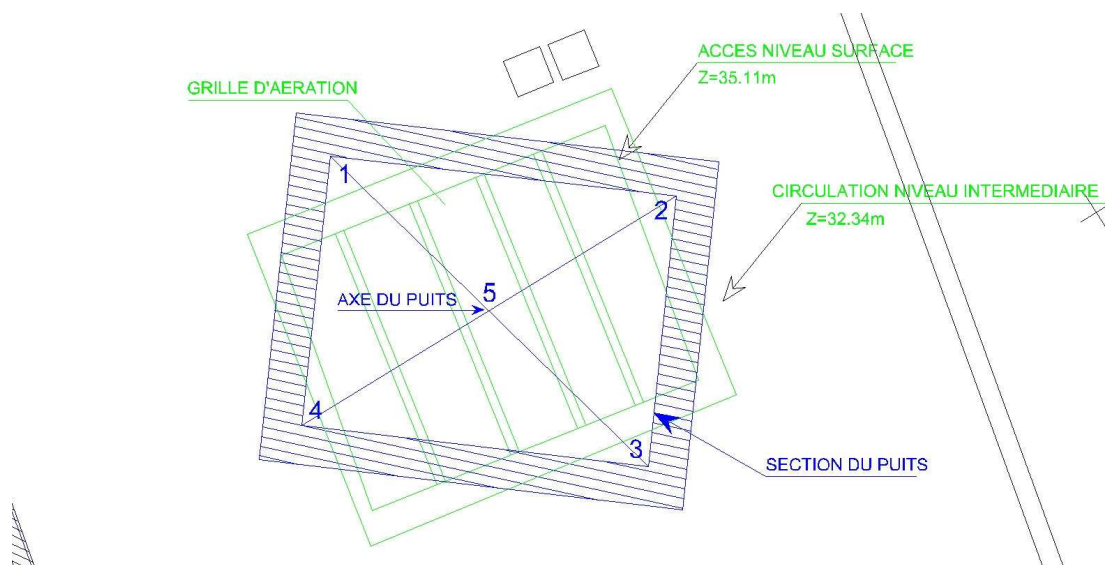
Vue en plan des ouvrages (situation de l'existant)
